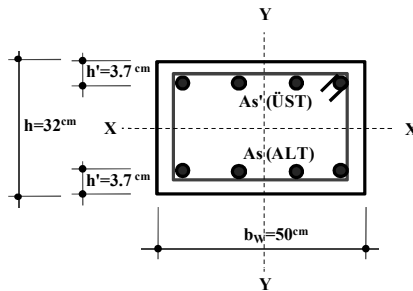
7KÇB'de Tipik Kolon Detayları
